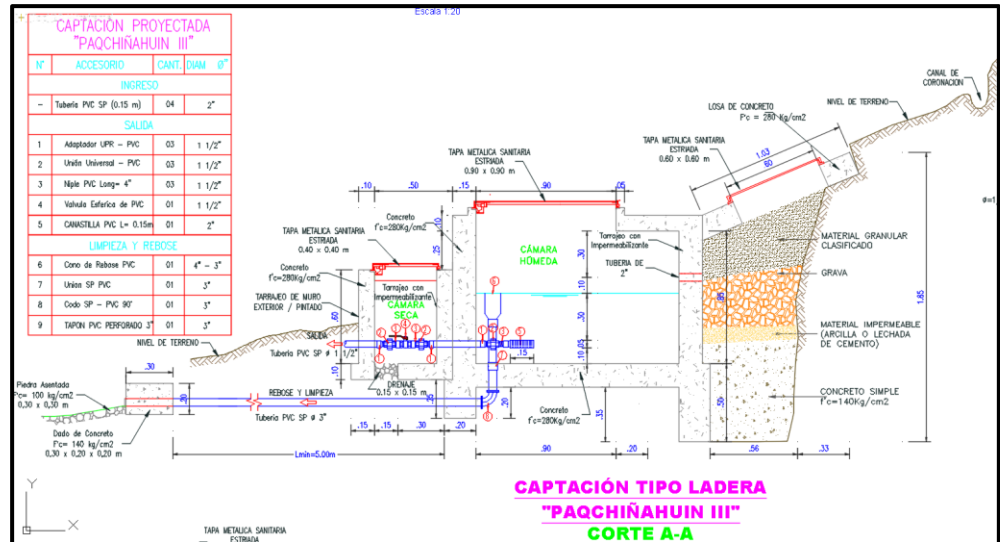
Planteamiento de Captación Tipo Ladera Corte A-A
